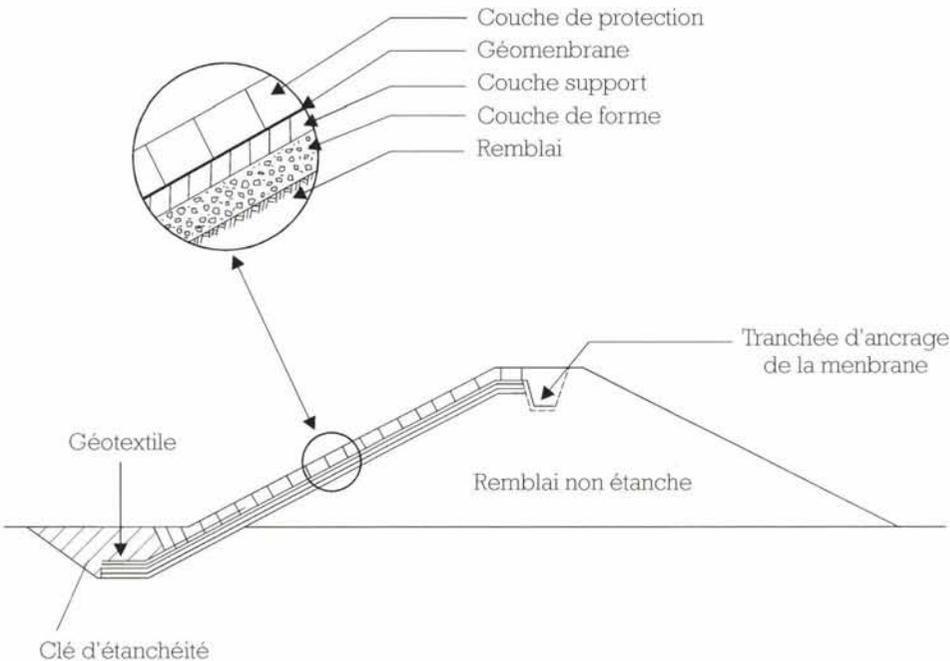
Exemple de barrage en remblai non étanche muni d'un dispositif d'étanchéité par géomembrane, avec ancrage de pied dans une clef d'étanchéité (source : C.I.G.B. ; [56]).
